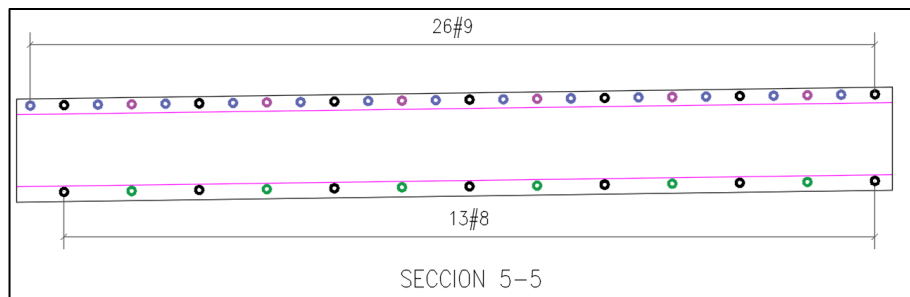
Refuerzo suministrado corte 5-5 – FIN
